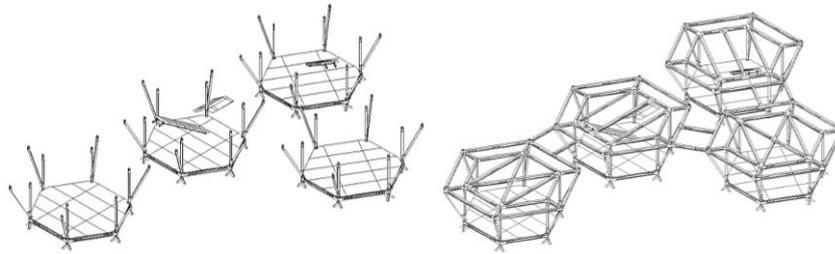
Estructura vertical y vigas principales en segundo nivel.
